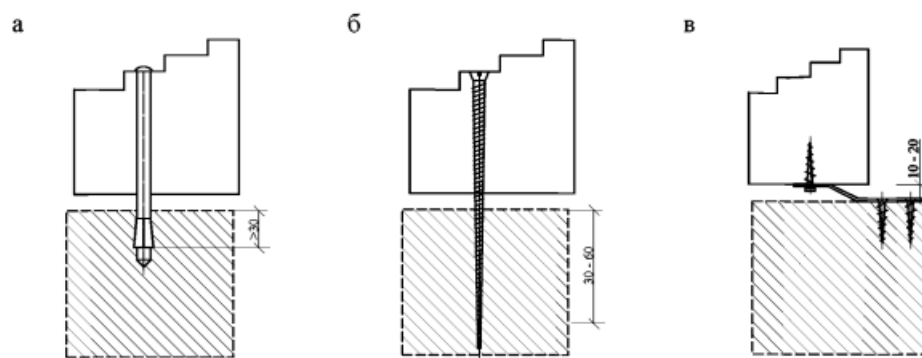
Приклади кріпильних вузлів: а – вузол кріплення будівельним дюбелем; б - вузол кріплення монтажним шурупом; в - вузол кріплення за допомогою анкерної пластини
